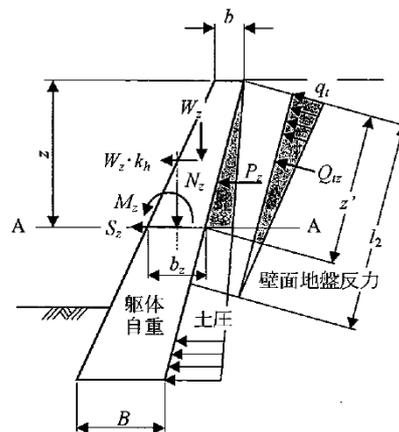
躯体に作用する荷重と断面力の考え方⁸⁾
